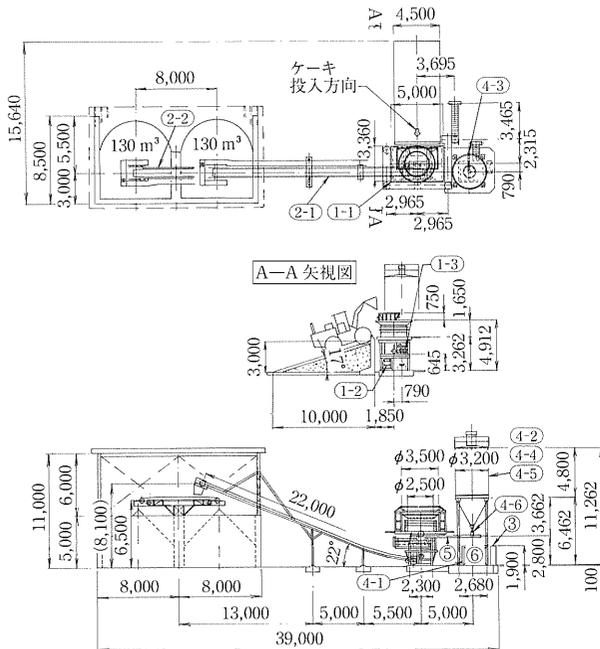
汚泥（脱水ケーキ）処理設備全体配置図
